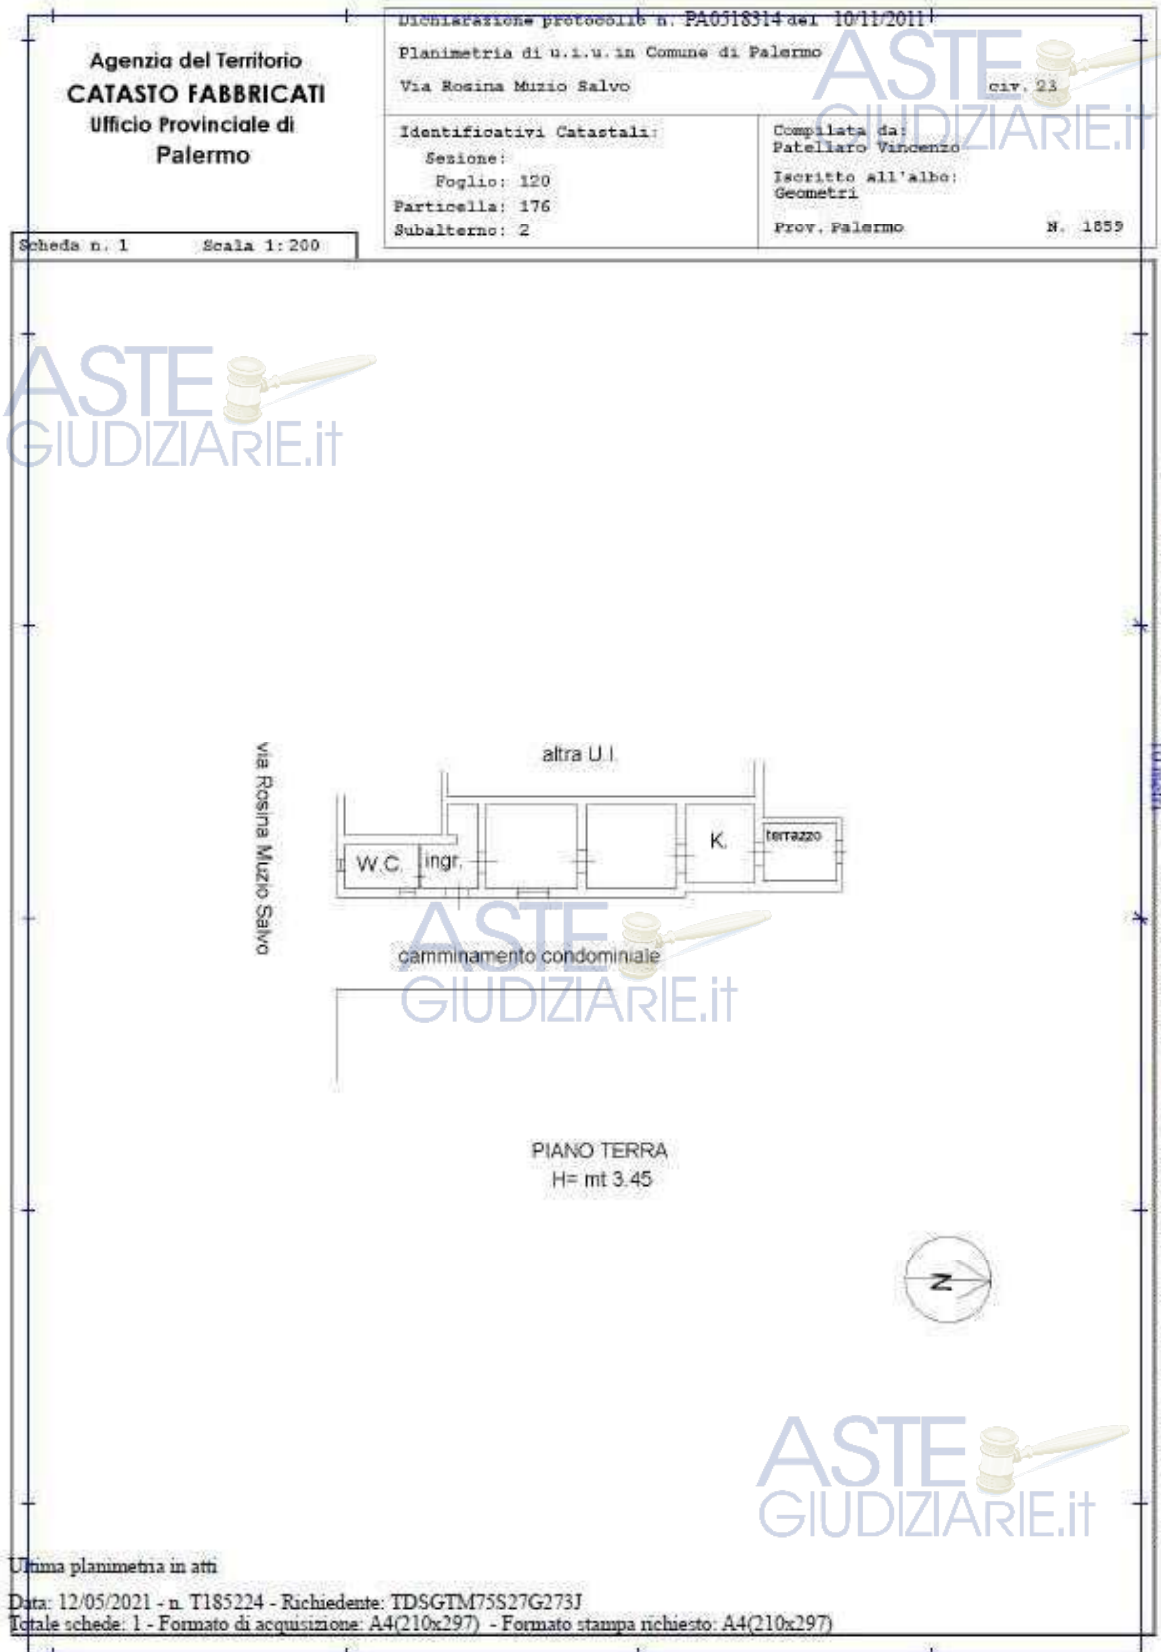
Planimetria catastale attuale (aggiornata al 12/05/2021)
